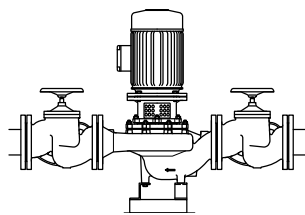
Struttura verticale / Fissaggio con 3 piedi di appoggio angolari (acciaio 37, accessori), grandezze costruttive da 032-032-160 a 100-100-125
